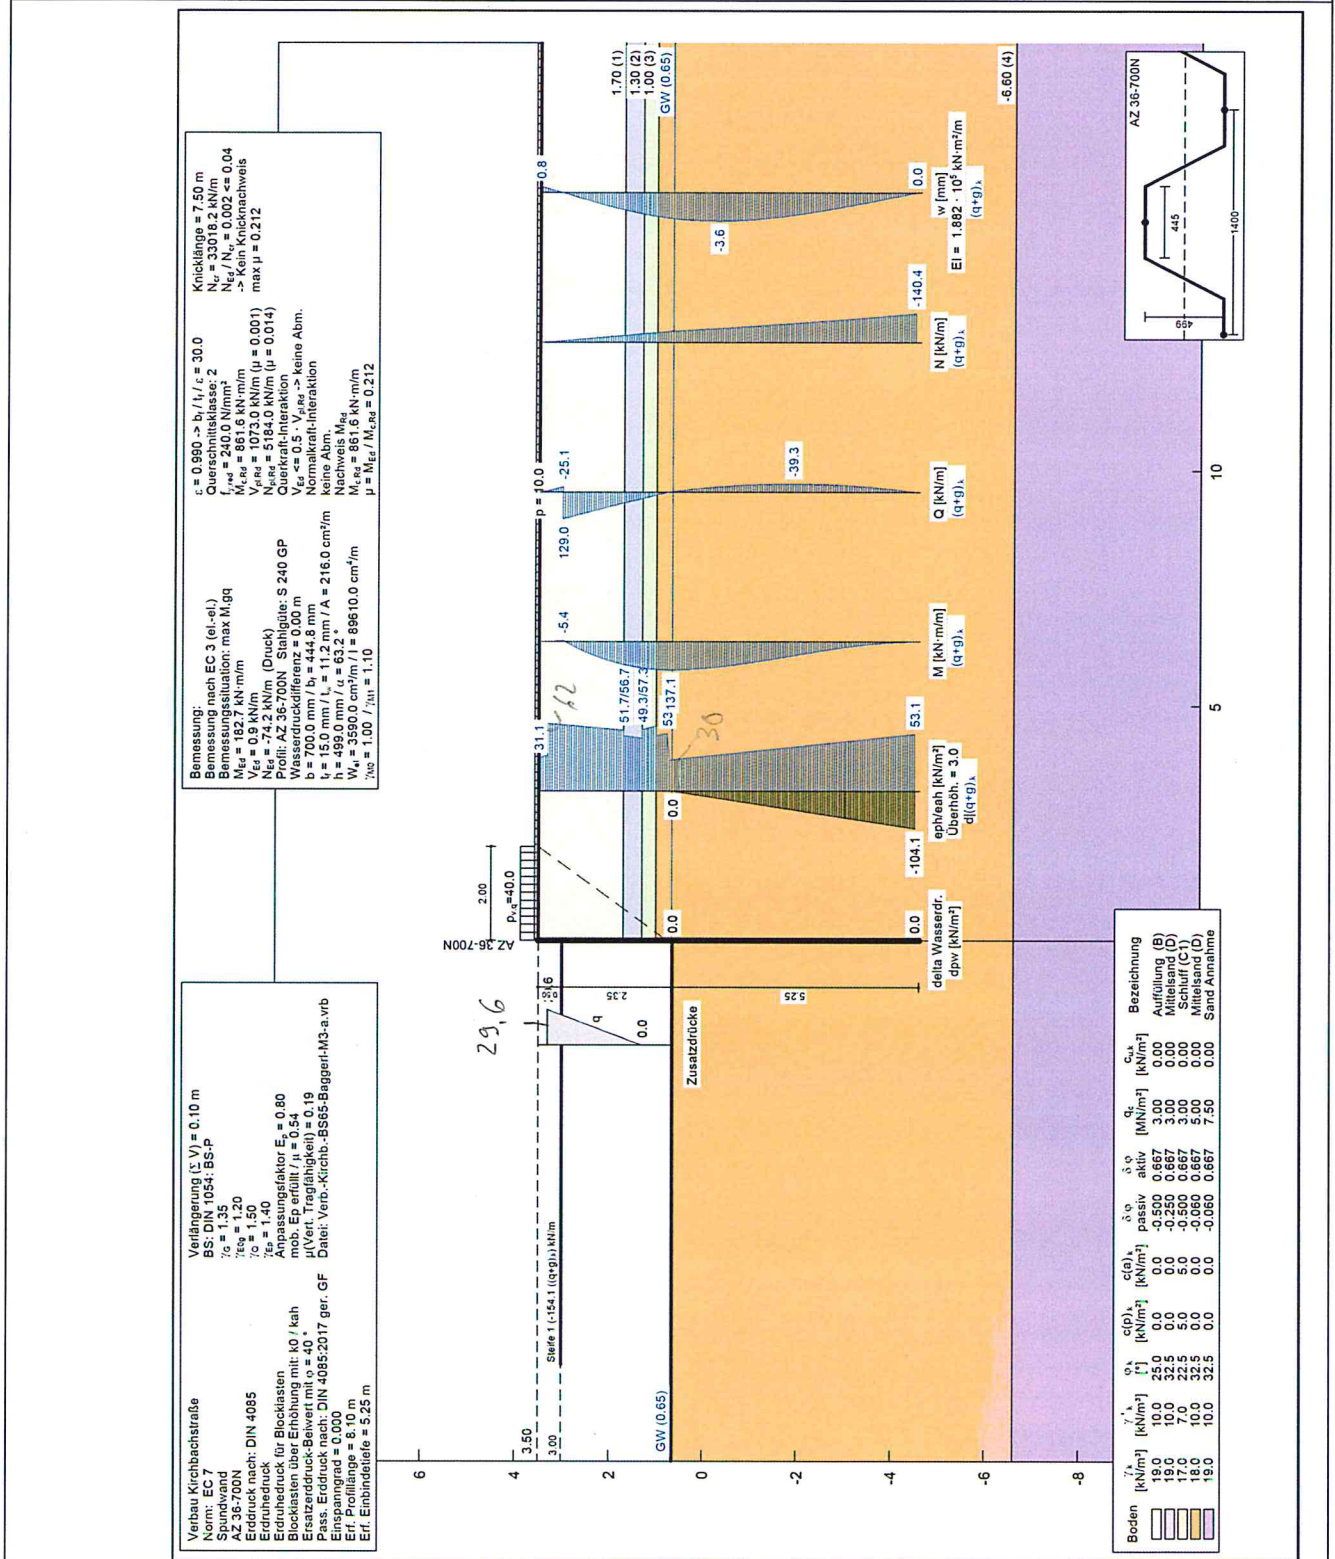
b Erdrücke -Im Bereich Mast M3-BS65
